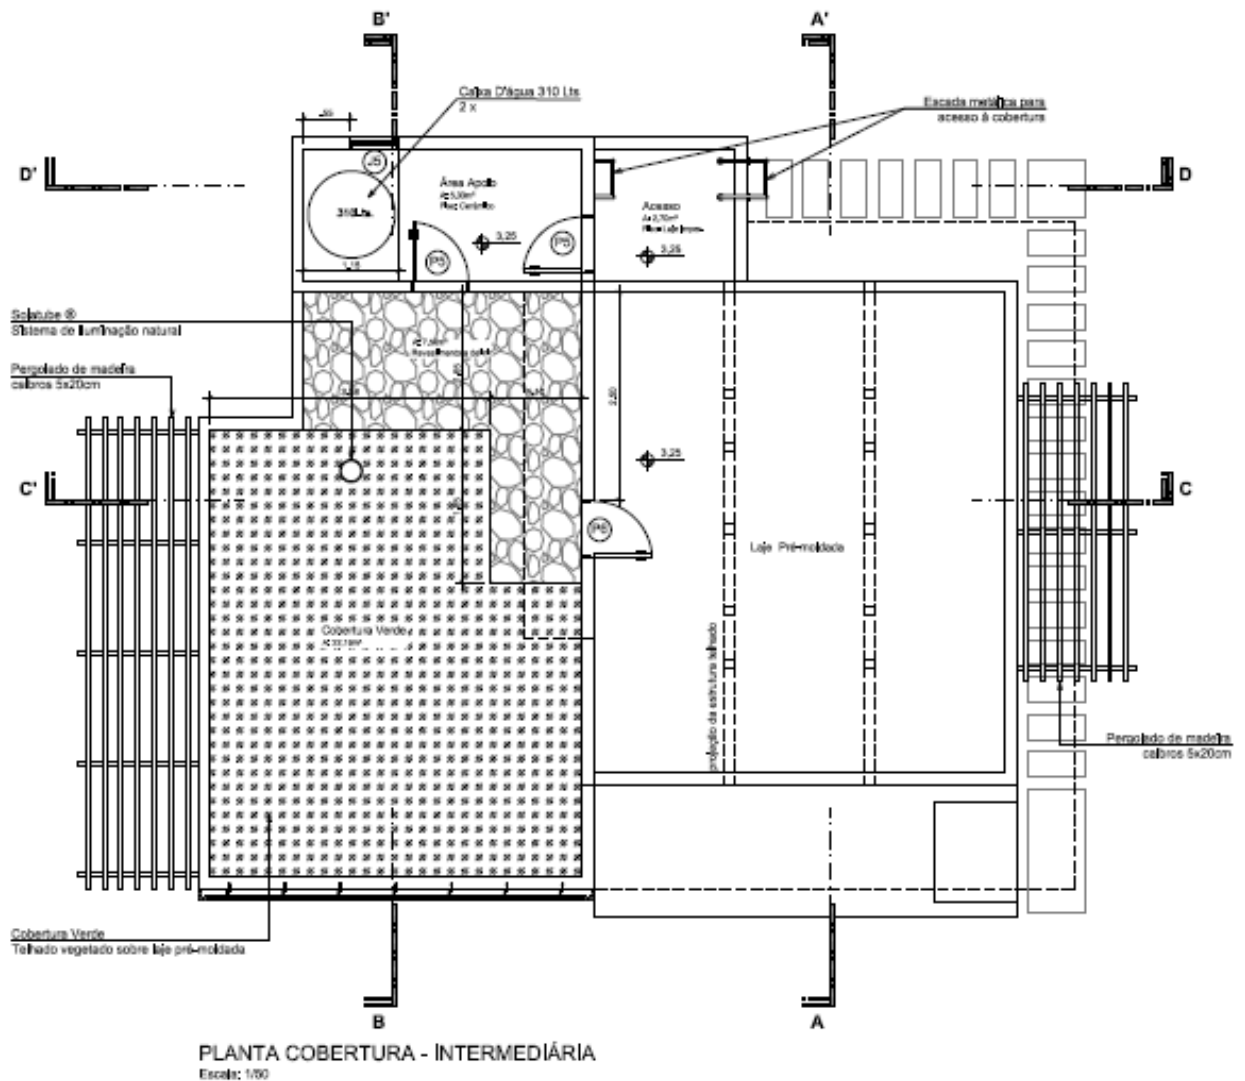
Planta da cobertura (Fonte: Arquivo pessoal).
